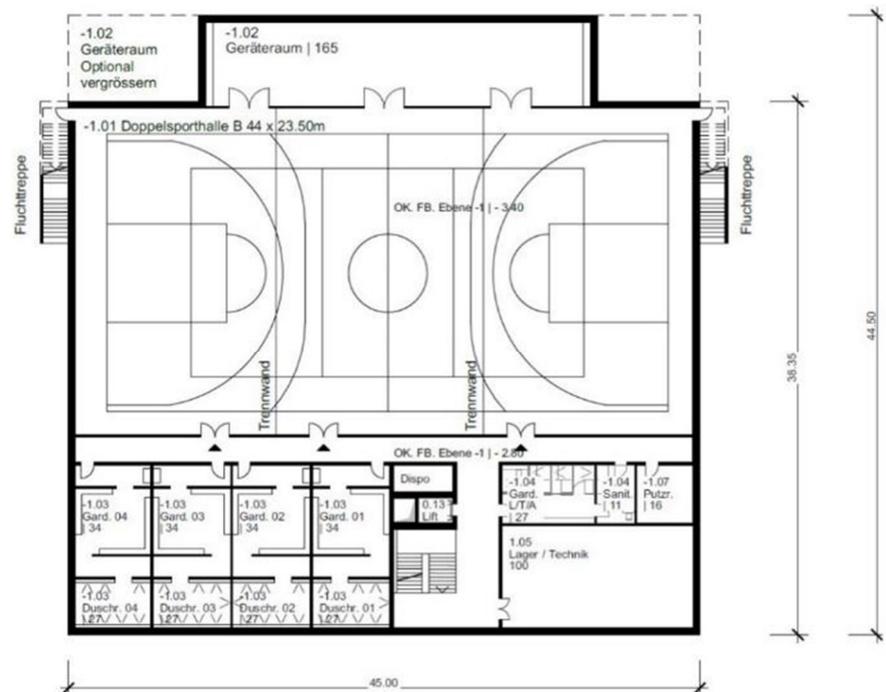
„versenkte“ Doppelsporthalle B | Disposition 1 - Grundriss 1. Untergeschoss
